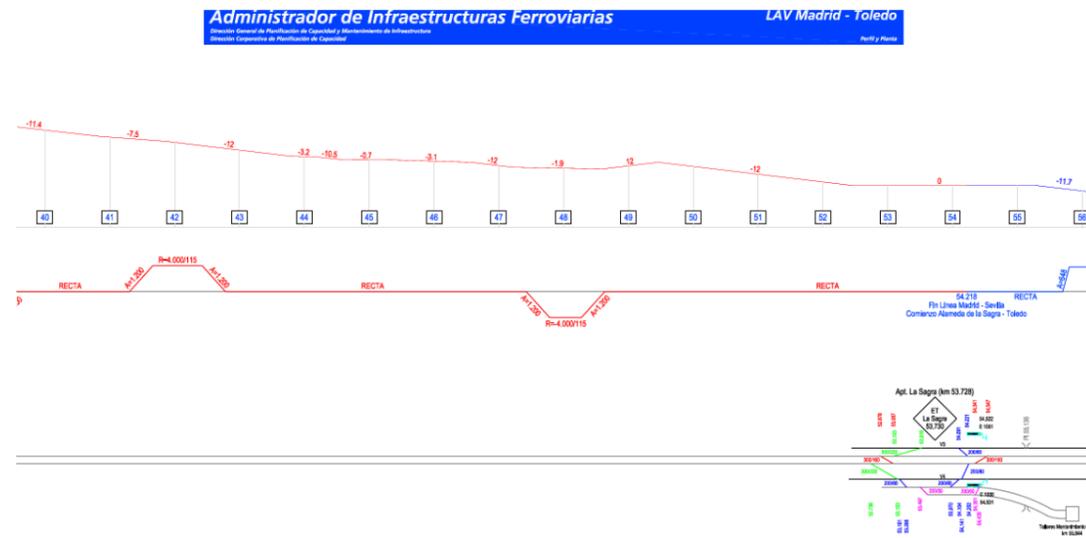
Planta y perfil longitudinal LAV Madrid – Toledo (PP.KK. 40+000 a 56+000). Fuente: ADIF
